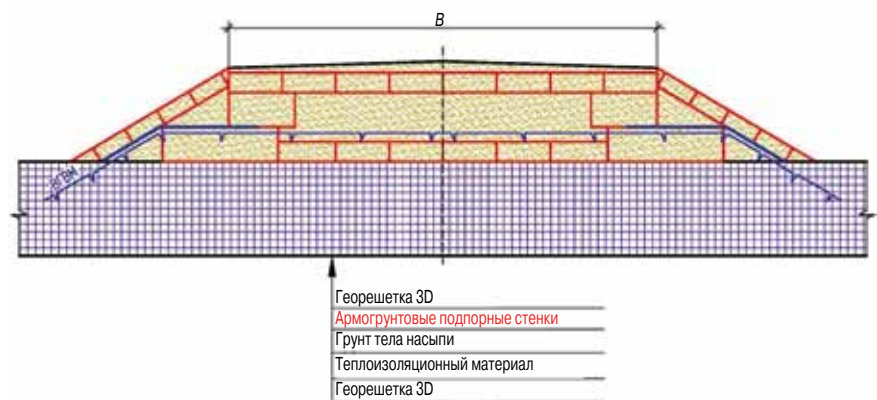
Пример геоимплантантной системы (ГИС) – дорожное основание, армированное несколькими ГИК [3]
